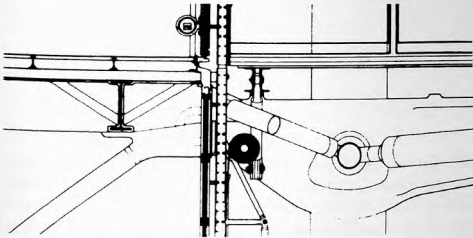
Conexão entre gerberette e treliça : Beaubourg
